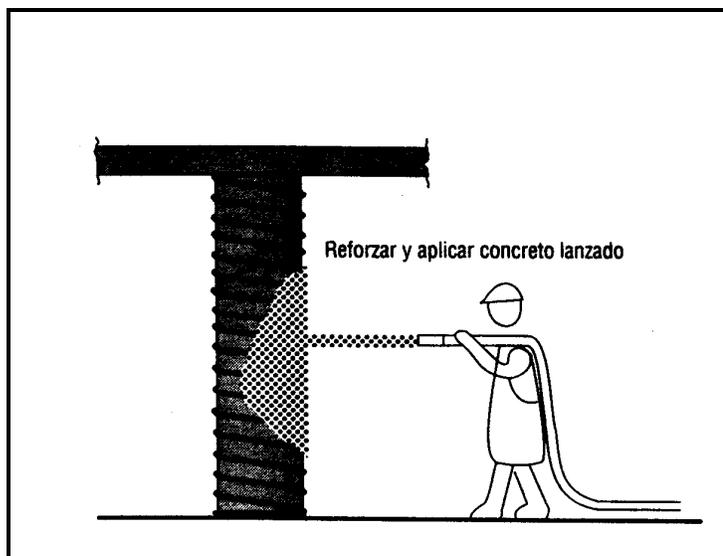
Revestimiento de columna con concreto lanzado^{1/}.
